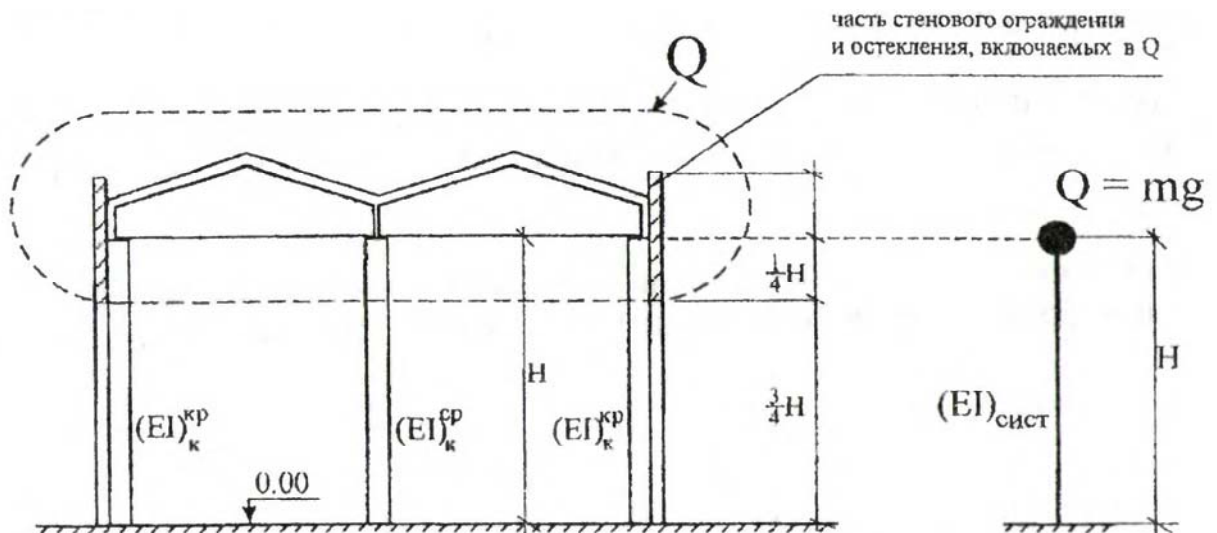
Формирование динамической расчетной схемы при шарнирном сопряжении стропильной конструкции с колоннами
